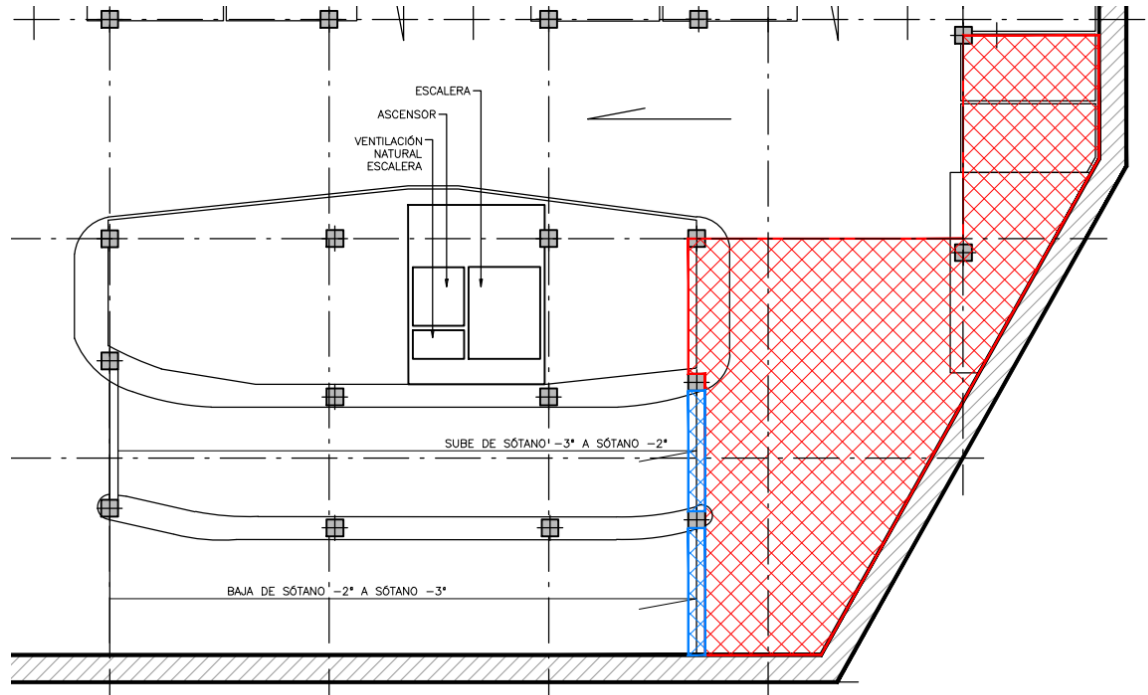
Ejemplo de zuncho entre arranque rampas y paños o demoler.
